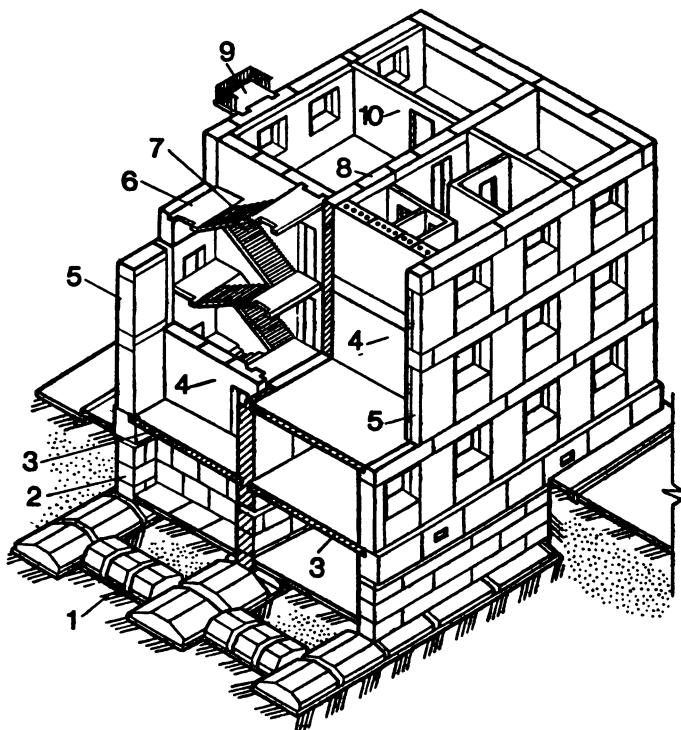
Конструктивная схема крупноблочного здания с поперечными и продольными несущими стенами:
